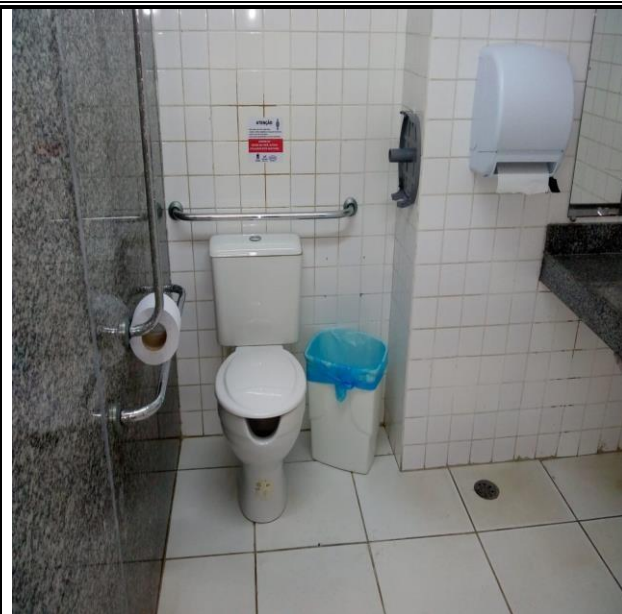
FOTO DEPOIS: COLOCAÇÃO DO ASSENTO SANITÁRIO
